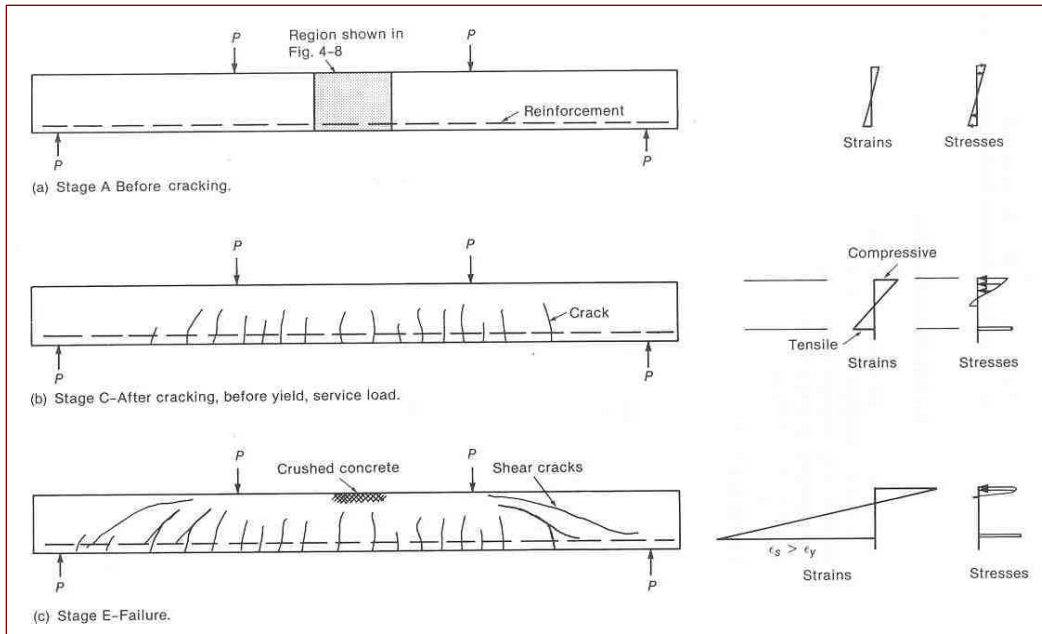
Grietas, deformaciones unitarias y esfuerzos en una viga de prueba.
